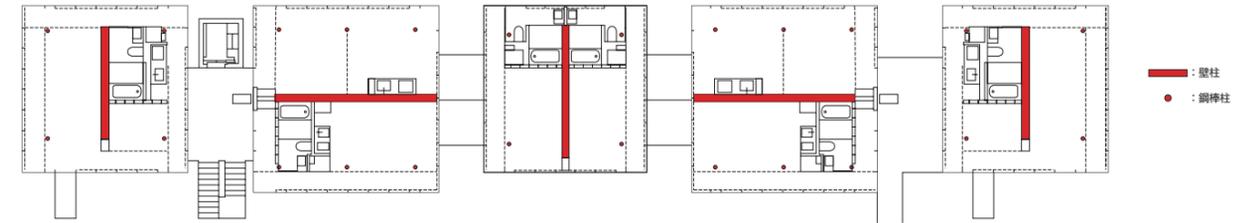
b 洗足の連結住棟 基準階平面図 縮尺1/300
